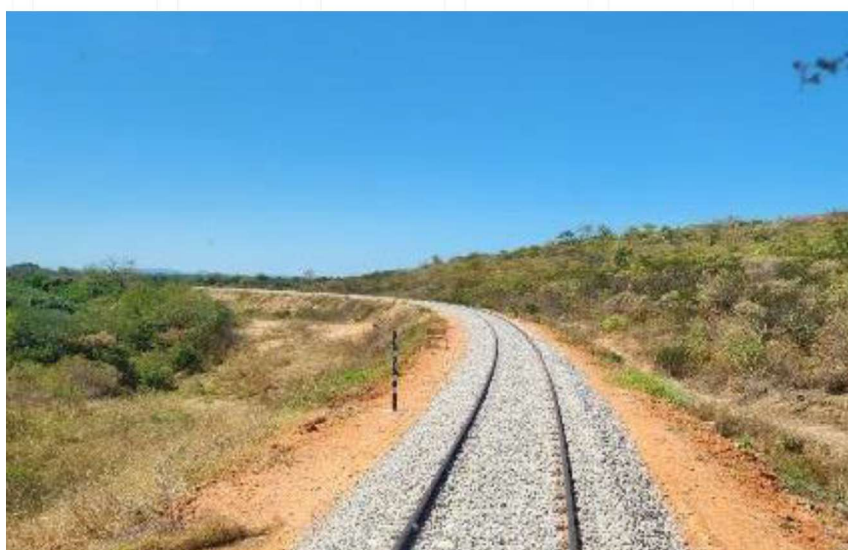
Início da montagem da superestrutura no trecho km 248+360.
